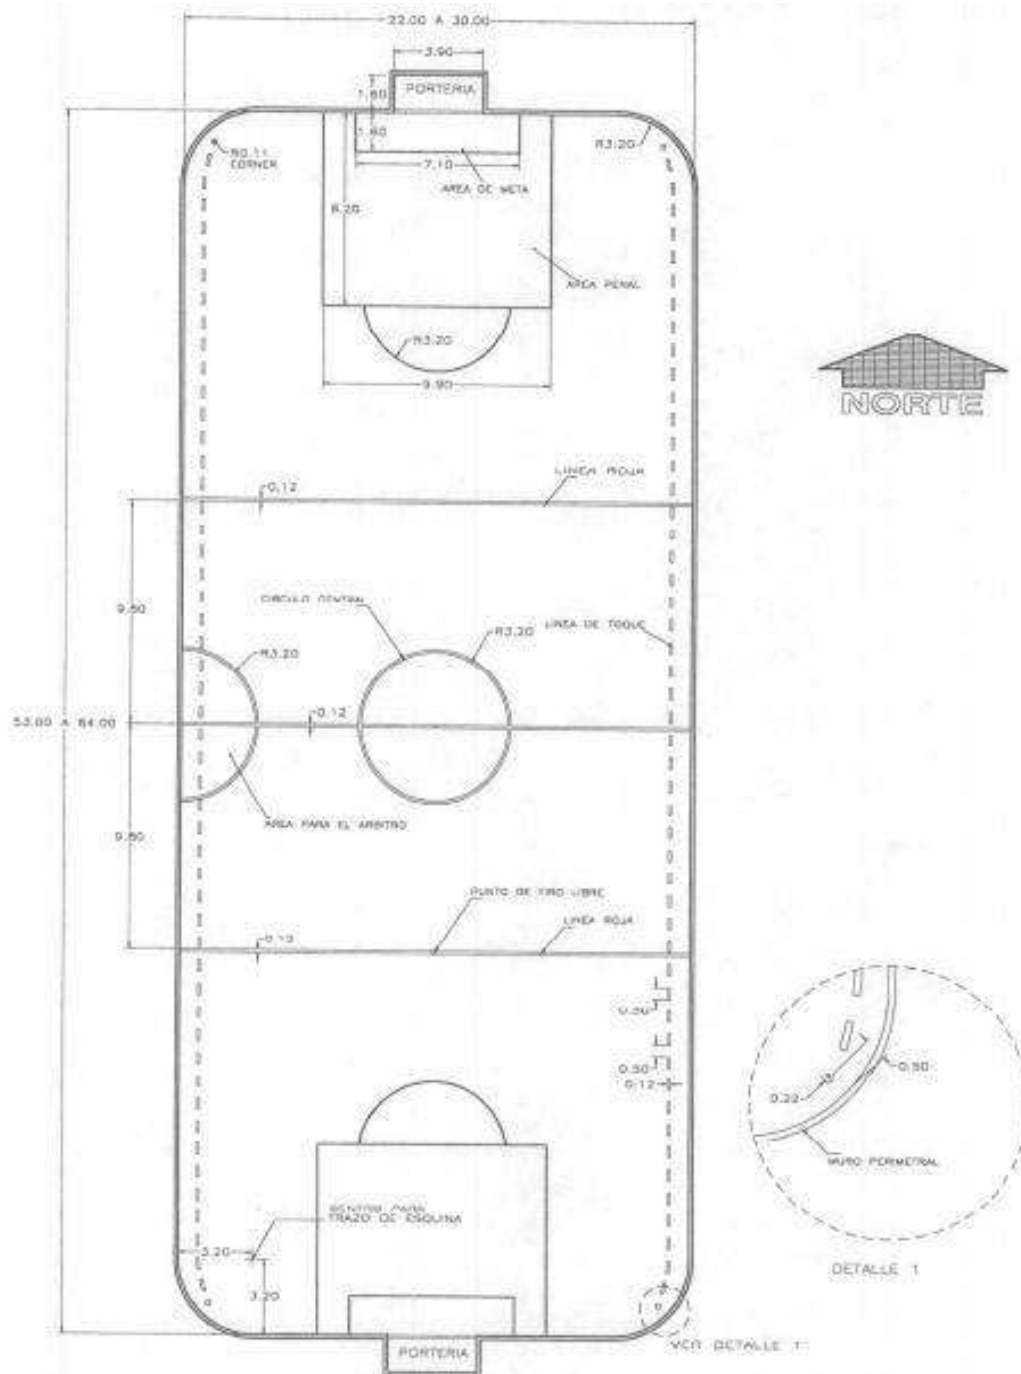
dibujo en planta de cancha de futbol soccer. Fuente: normatividad para la infraestructura del deporte CONADE.
